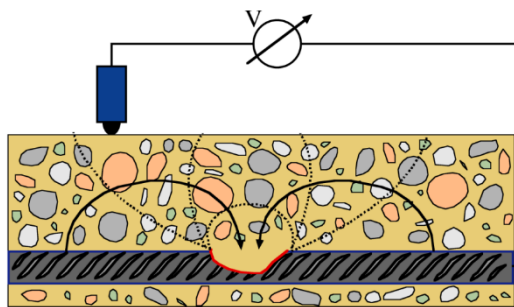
Messaufbau zur Bestimmung des Bewehrungspotentials. Der Ionenstrom im Beton (durchgezogene Linie) führt zu einem Spannungsabfall (gestrichelte Linie), der an der Betonoberfläche gemessen werden kann [166].
